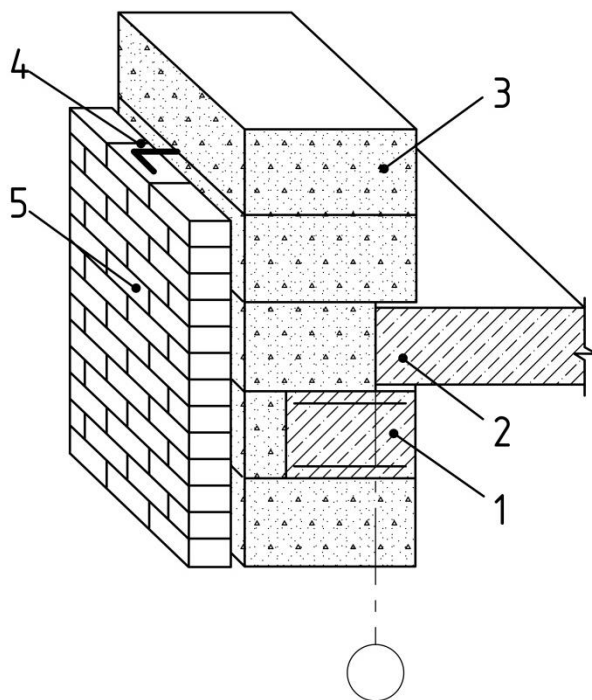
Стена из легковесных блоков с облицовкой кирпичом:
